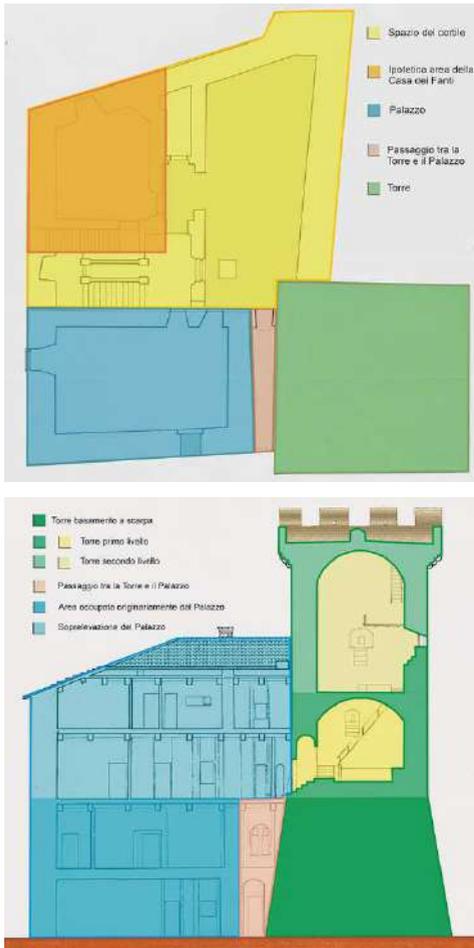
Planimetria e sezione trasversale della Rocca. Le campiture evidenziano le diverse aree che compongono la fortezza (Elaborazione dell'autore).
